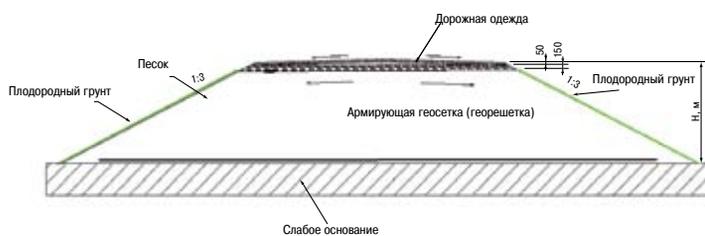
Схема насыпи с применением плоских геосеток (георешеток)
